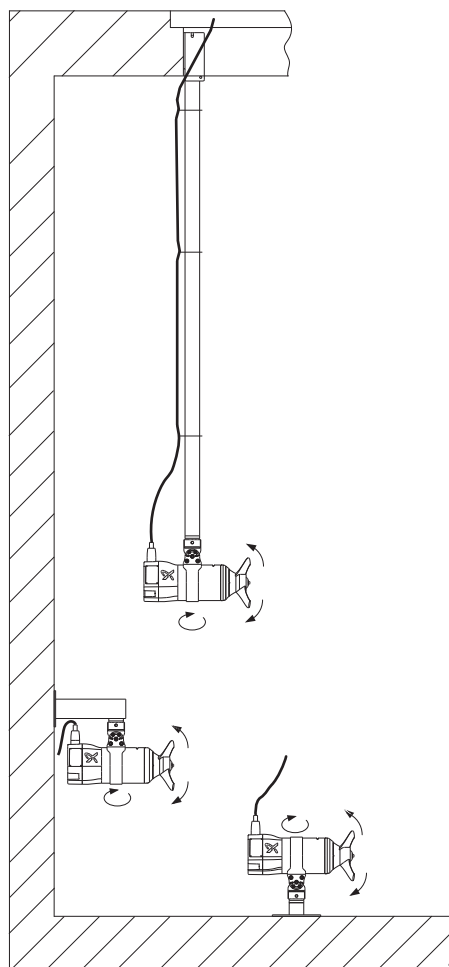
Подвесной, настенный и напольный монтаж SMD.09-18
